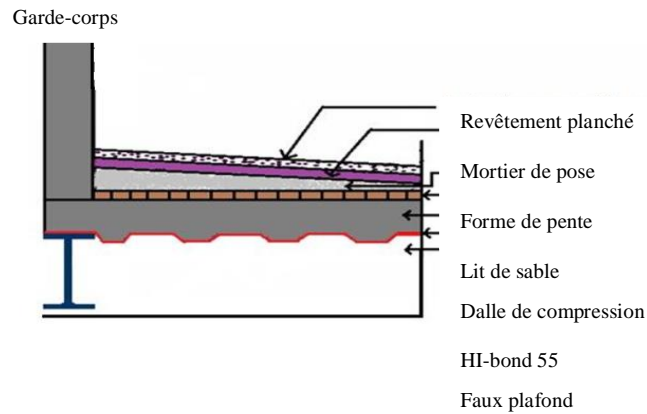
Plancher terrasse accessible (PFE-TABET-BOUAYAD)
